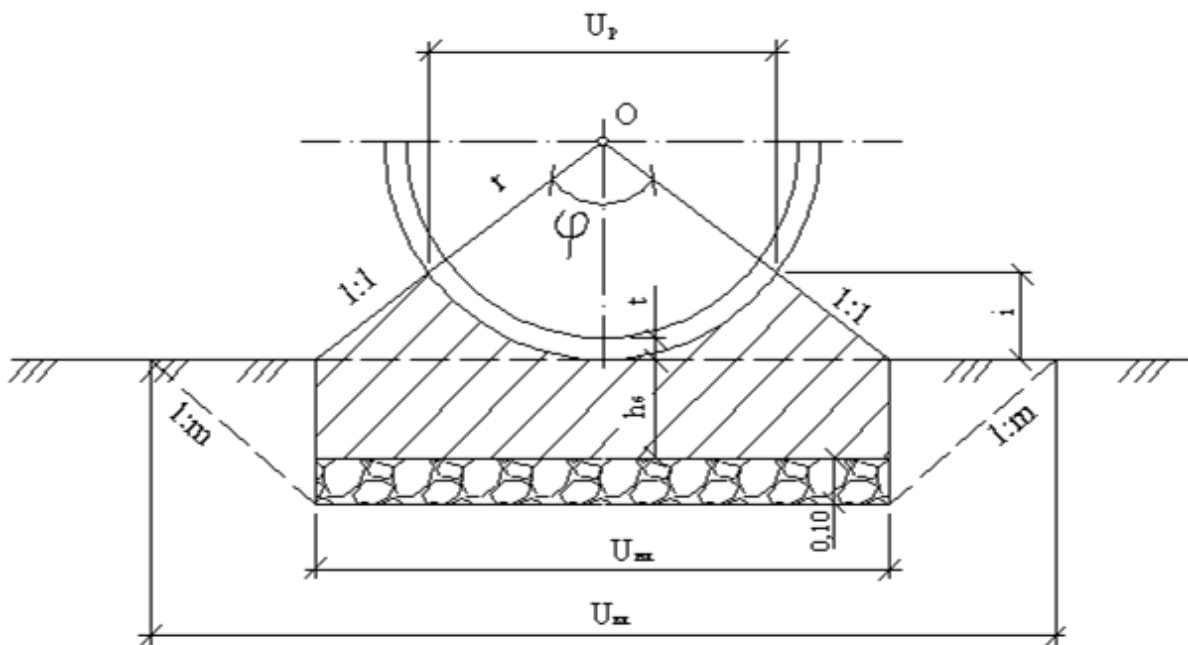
Поперечное сечение фундаментной трубы
